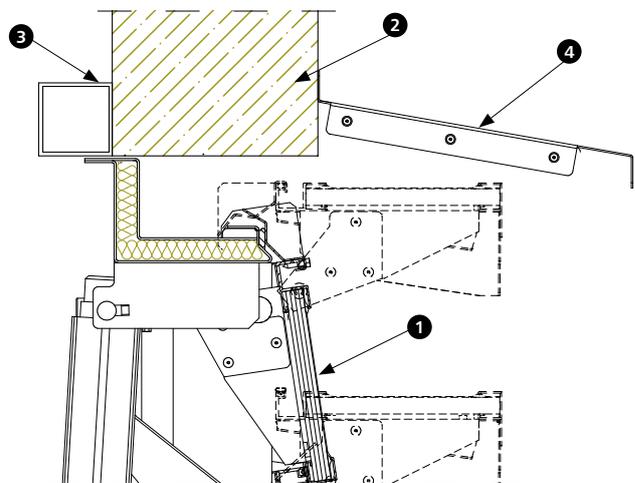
Montage des Lamellenlüfters in der Wand (Fassade) zum tragendes Stahlprofil, z.B. Auswechslung, Pfette
